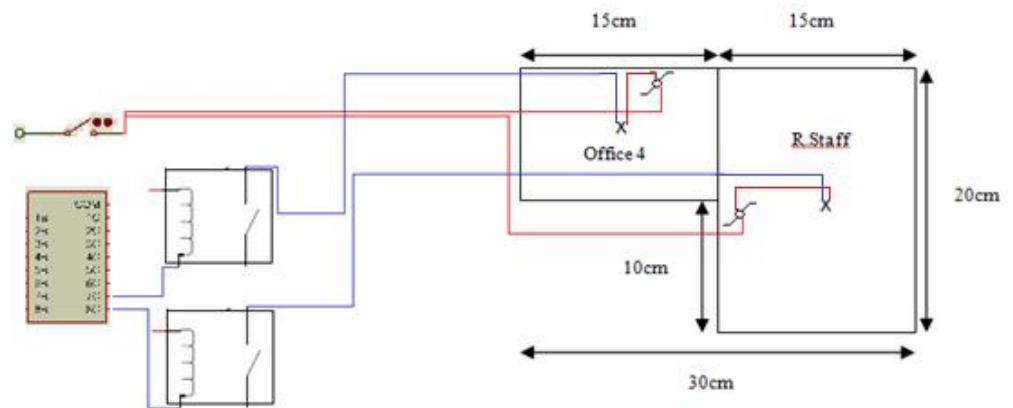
Denah Diagram Tunggal Maket Lantai 1
